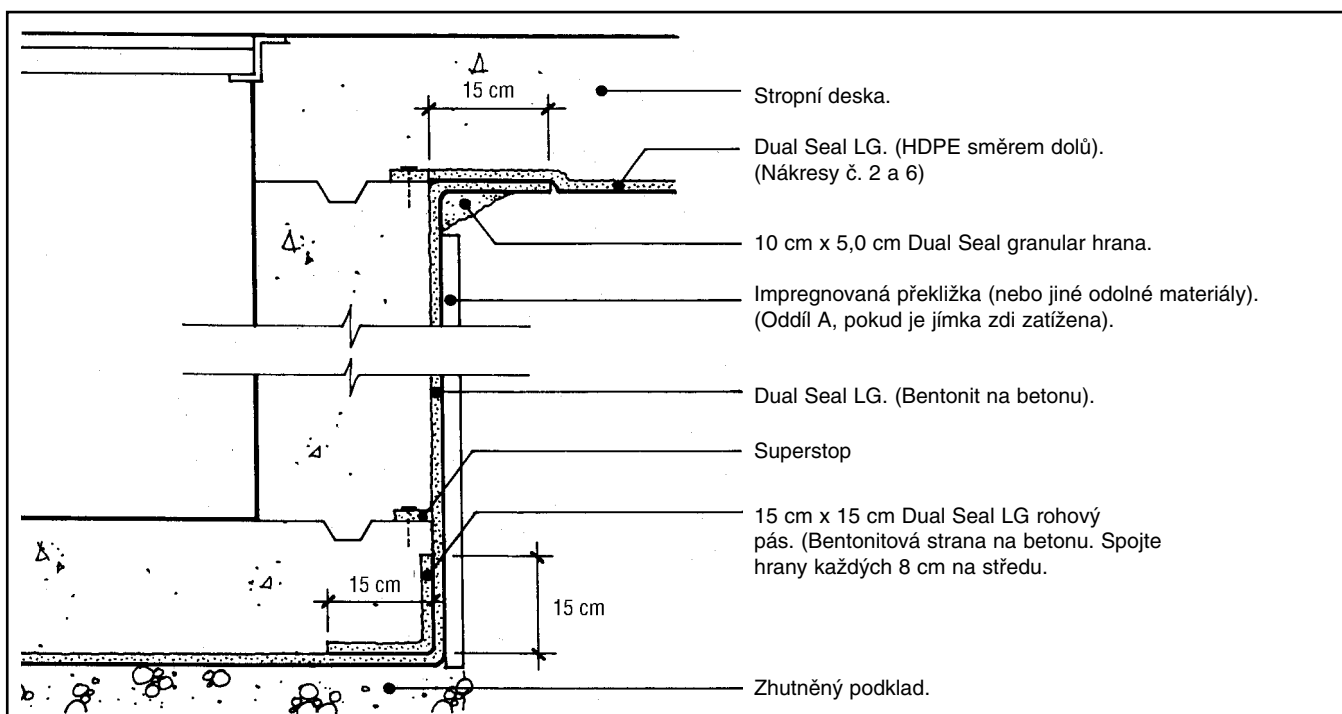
Izolace betonové patky s napojením na izolaci podlahy.
